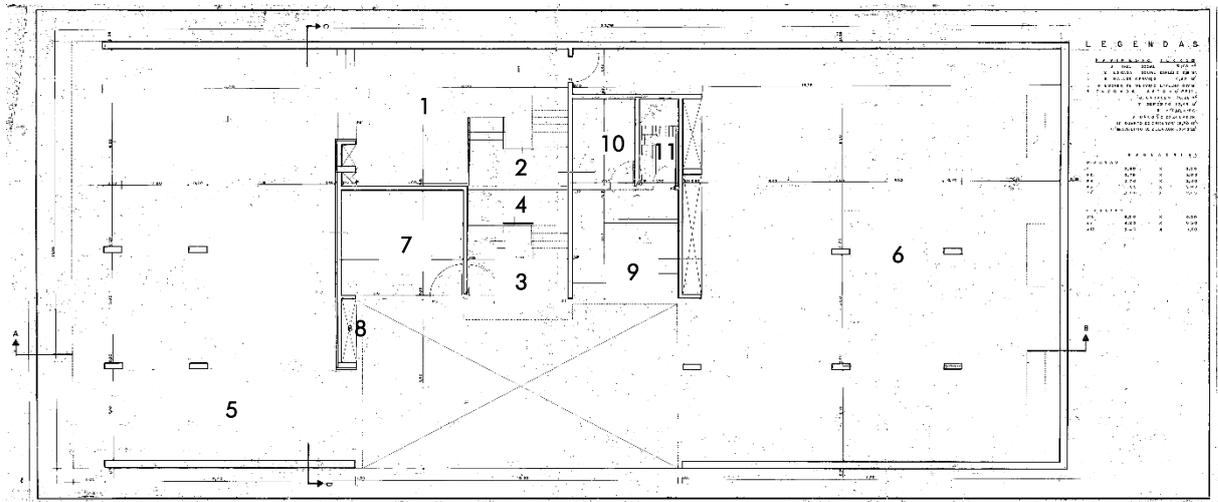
Planta-baixa pavimento térreo Ed. Nice. Programa: 1. Hall social; 2. Escada social; 3. Hall de serviço; 4. Escada de serviço; 5. Entrada automóvel; 6. Garagem; 7. Depósito; 8. Medidores; 9. Balcão do zelador; 10. Quarto zelador; 11. Banheiro zelador.
